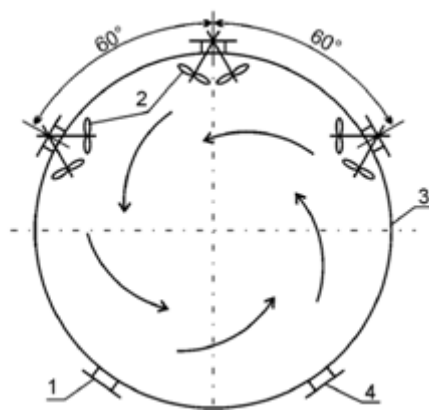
Схема установки в резервуаре винтовых смесителей: 1 – наливной патрубок; 2 – винтовой смеситель; 3 – стенка резервуара; 4 – сливной патрубок [8]
